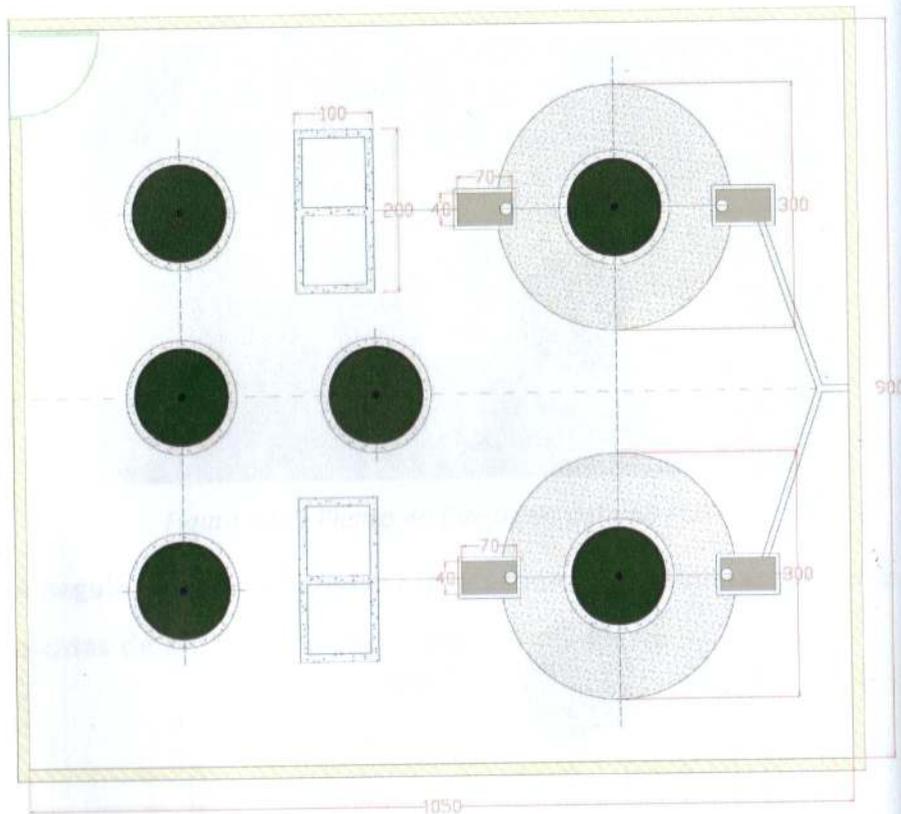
Planta de Biogás do sistema PUXTIL de 20 m³
